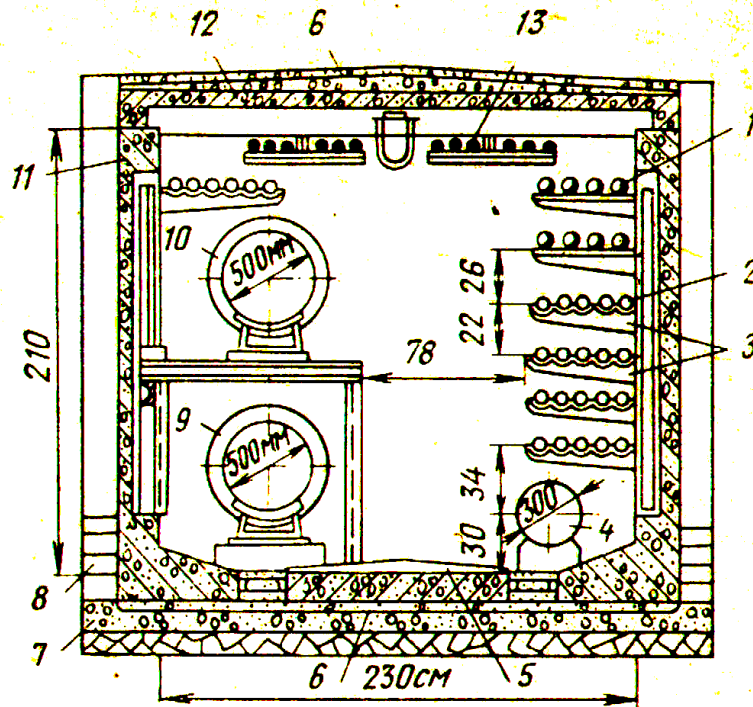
Поперечное сечение общего коллектора для подземных сетей: 1 – электрокабели; 2 – кабели связи; 3 – кронштейны; 4 – водопровод; 5 – железобетонный блок дна; 6 – оклеечная гидроизоляция; 7 – бетонная подготовка; 8 – кирпичная защитная стенка; 9 – теплопровод; 10 – обратный теплопровод; 11 – ребристый стеновой блок; 12 – плита перекрытия; 13 – кабели внутреннего обслуживания
